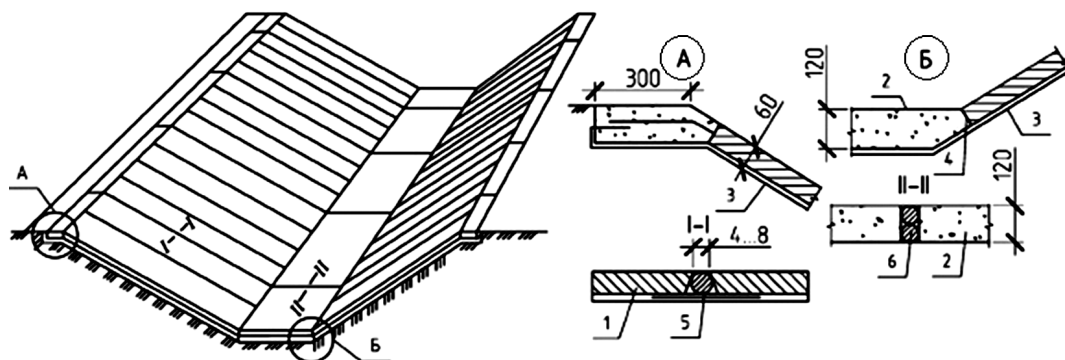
Принципиальное решение крепления откосов мелиоративного канала из сборного железобетона:
